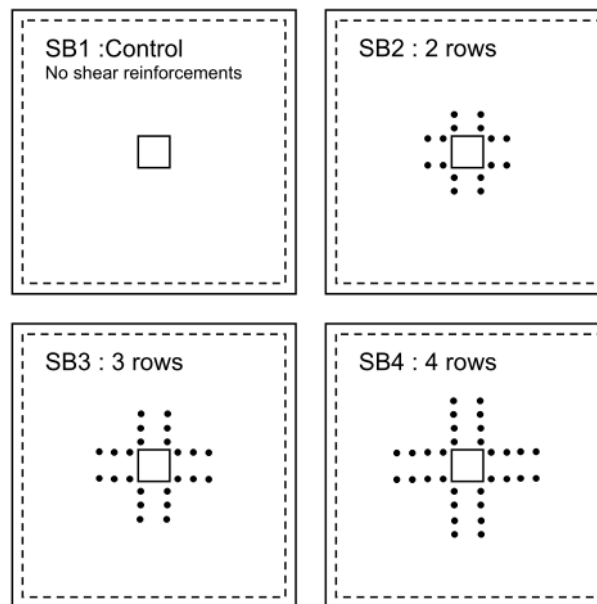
Planta do reforço com parafusos aplicado em cada modelo. Belakhdar (2008).
